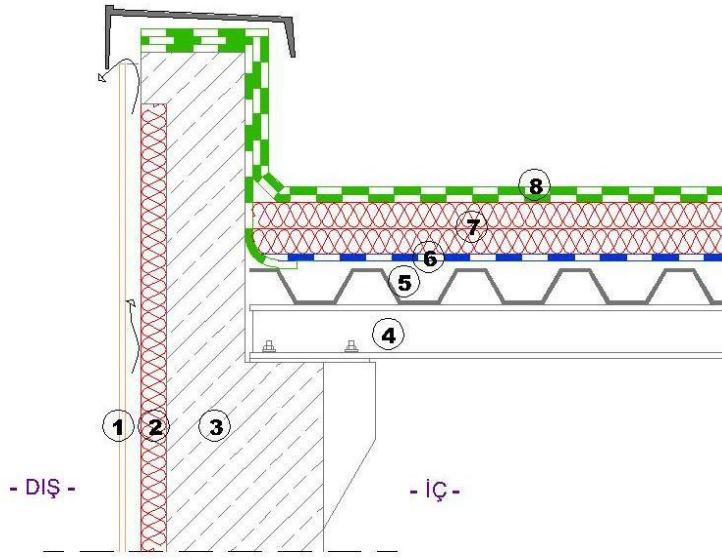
Çatı Arası Kullanılan – Isı Yalıtımı Çatı Paneli Üzerinde Yer Alan Çatılar - Detay C5
